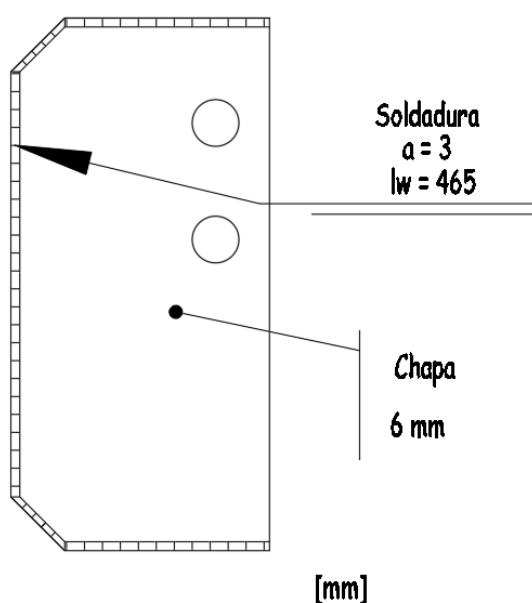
Chapa de ligação com cordão de soldadura
